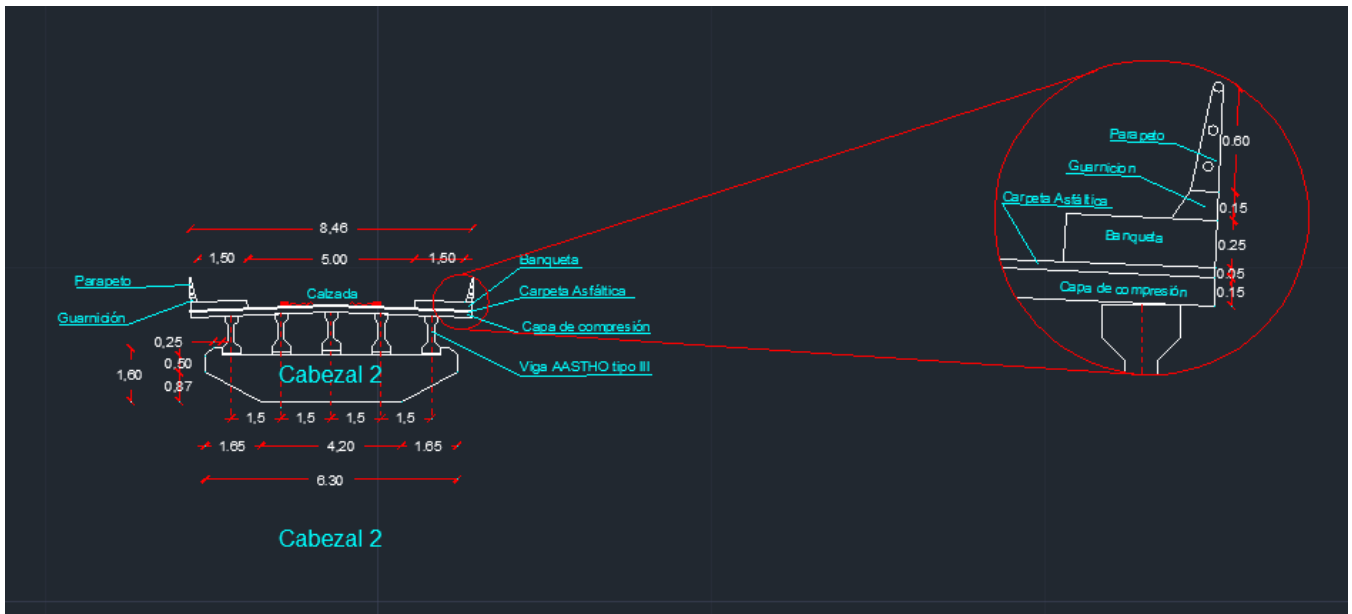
Planos arquitectónicos del Puente carretero Propuesto para el proyecto de investigación de Santa Fe de la Purísima.
